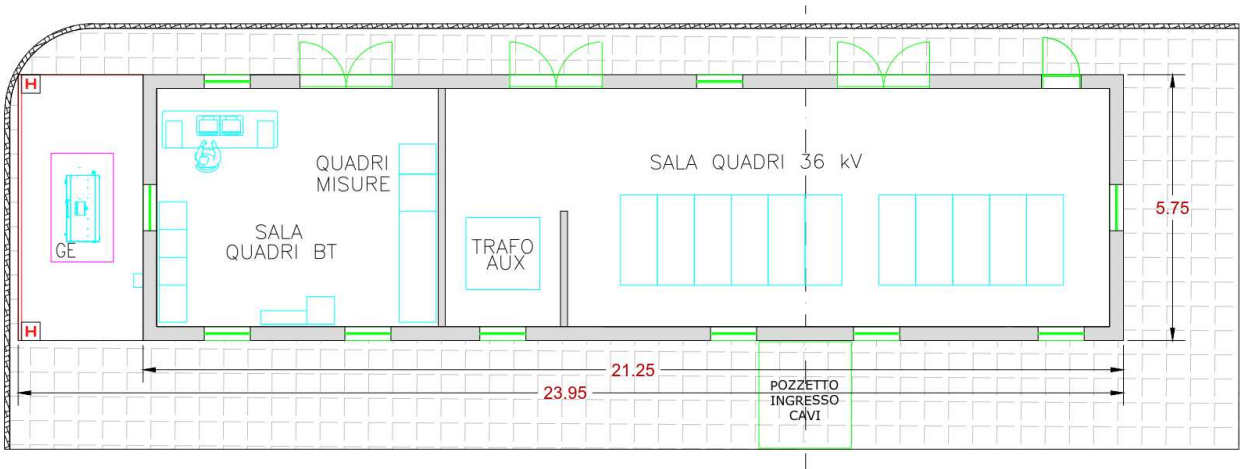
Pianta fondazioni dell'edificio della Cabina Utente
